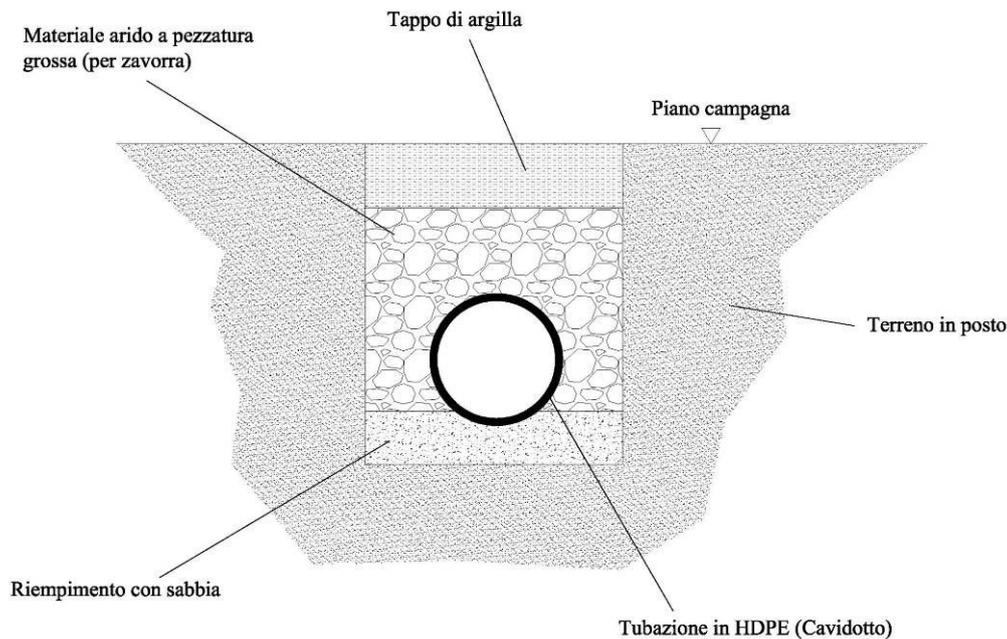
D - Schema tipo del cavidotto con sistema di zavorraggio e tenuta idraulica supplementare
